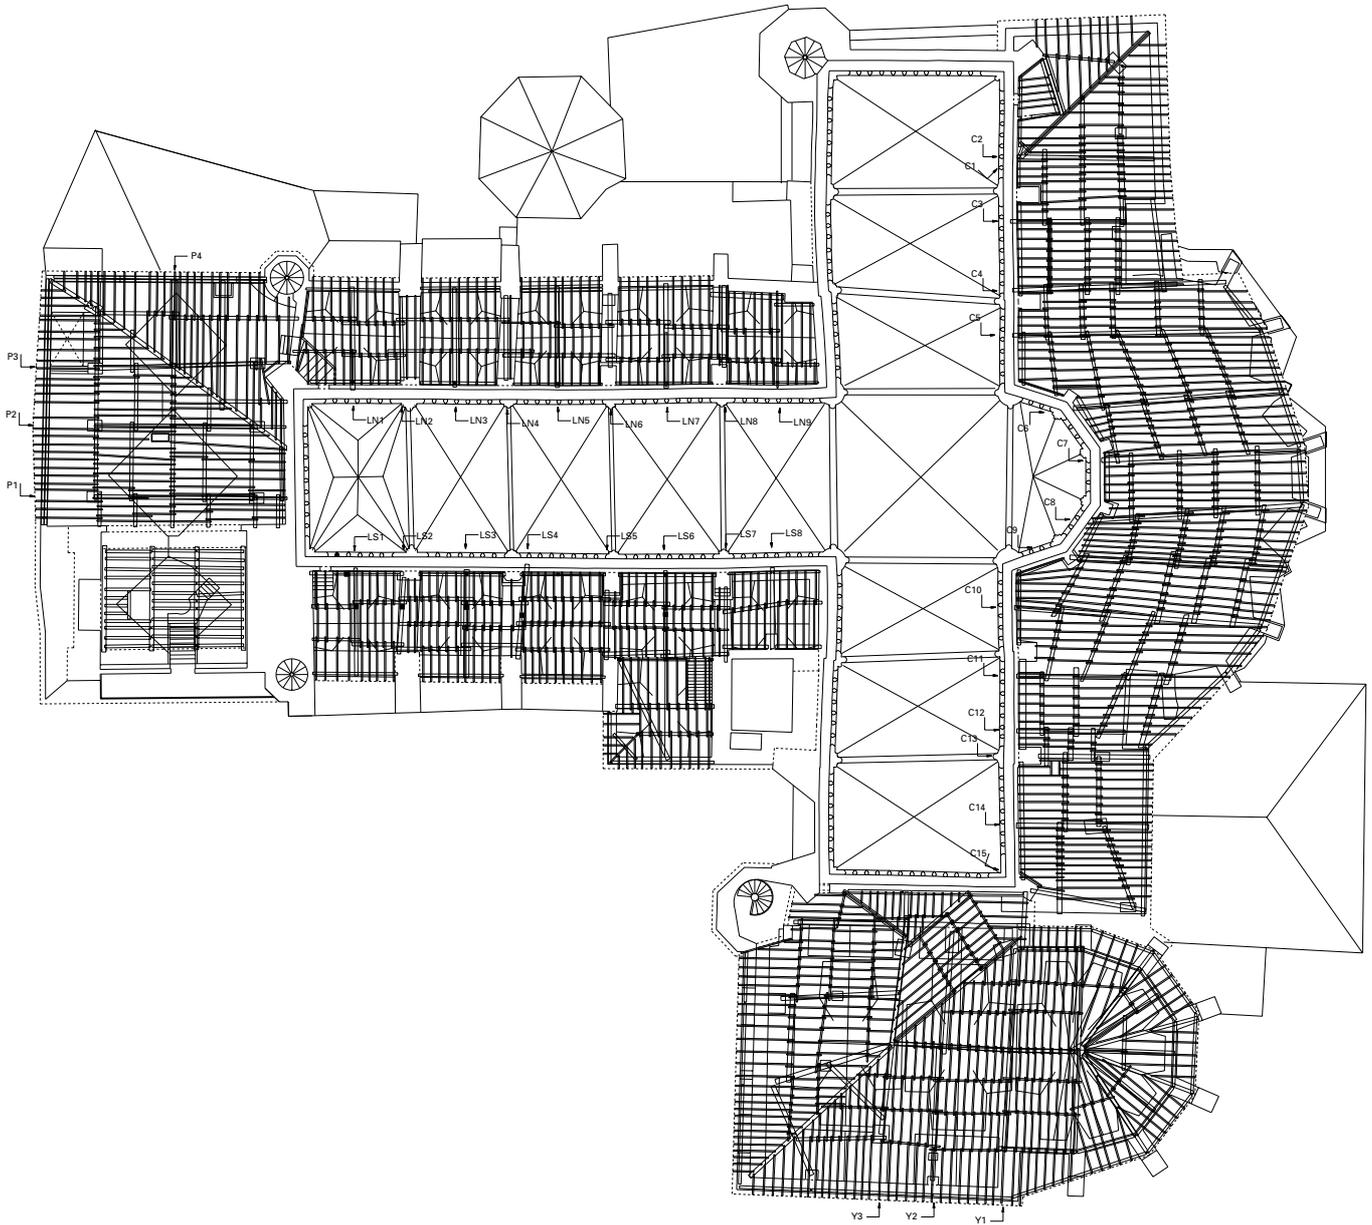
Estructuras de cubierta: naves laterales, girola y capilla de Santiago
